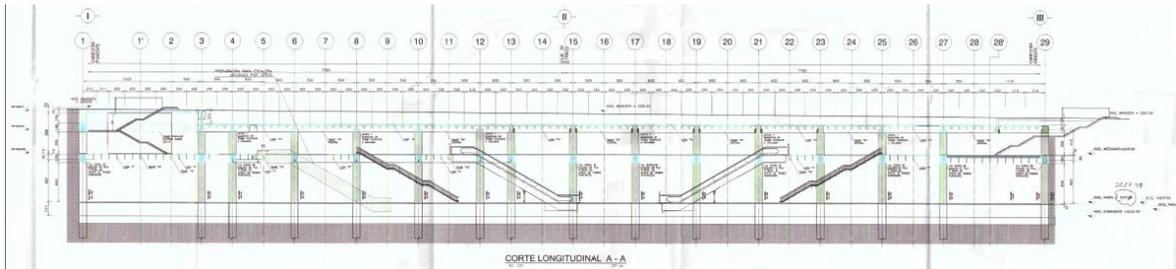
Corte longitudinal de Losa Nivel Mezzanine.
